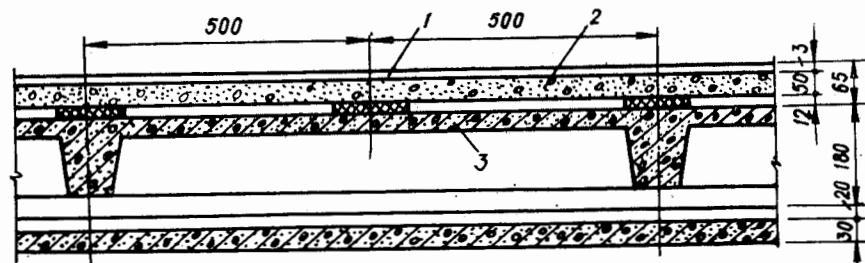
Конструкция отдельного перекрытия в объемно-блочных зданиях типа БК-4:
